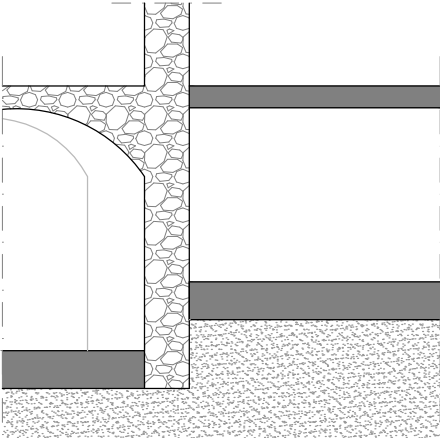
Se procederá al vertido de capa de 10 cm de hormigón de limpieza, colocaremos el armado de losa con separadores y esperas de los muros.
